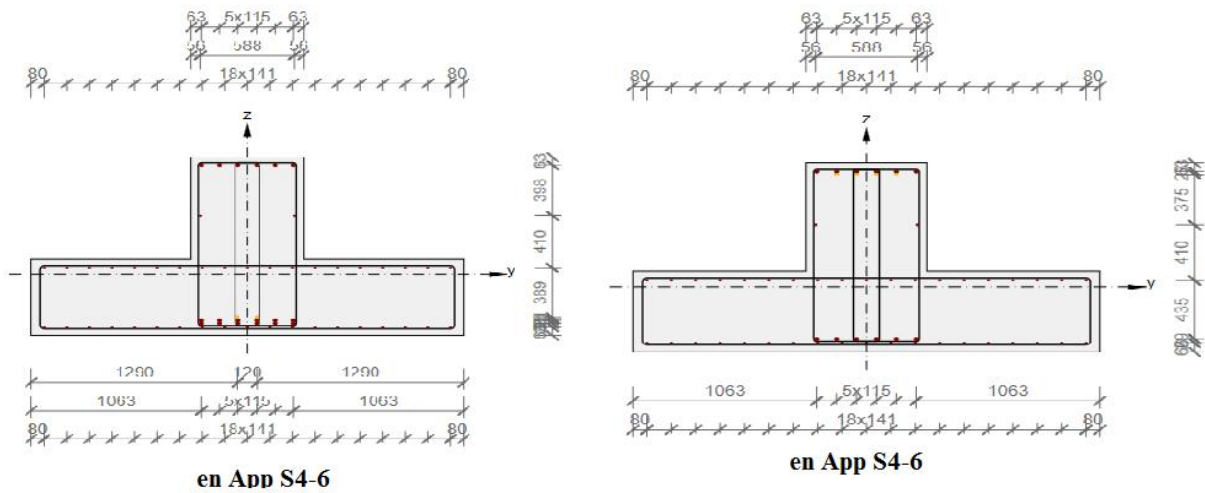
La coupe transversal des semelles (4 et 6).
